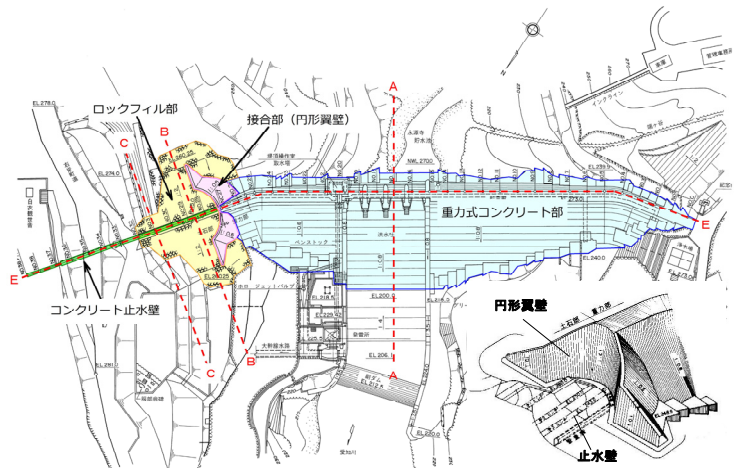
永源寺ダム周辺平面図及び円形翼壁鳥瞰図
